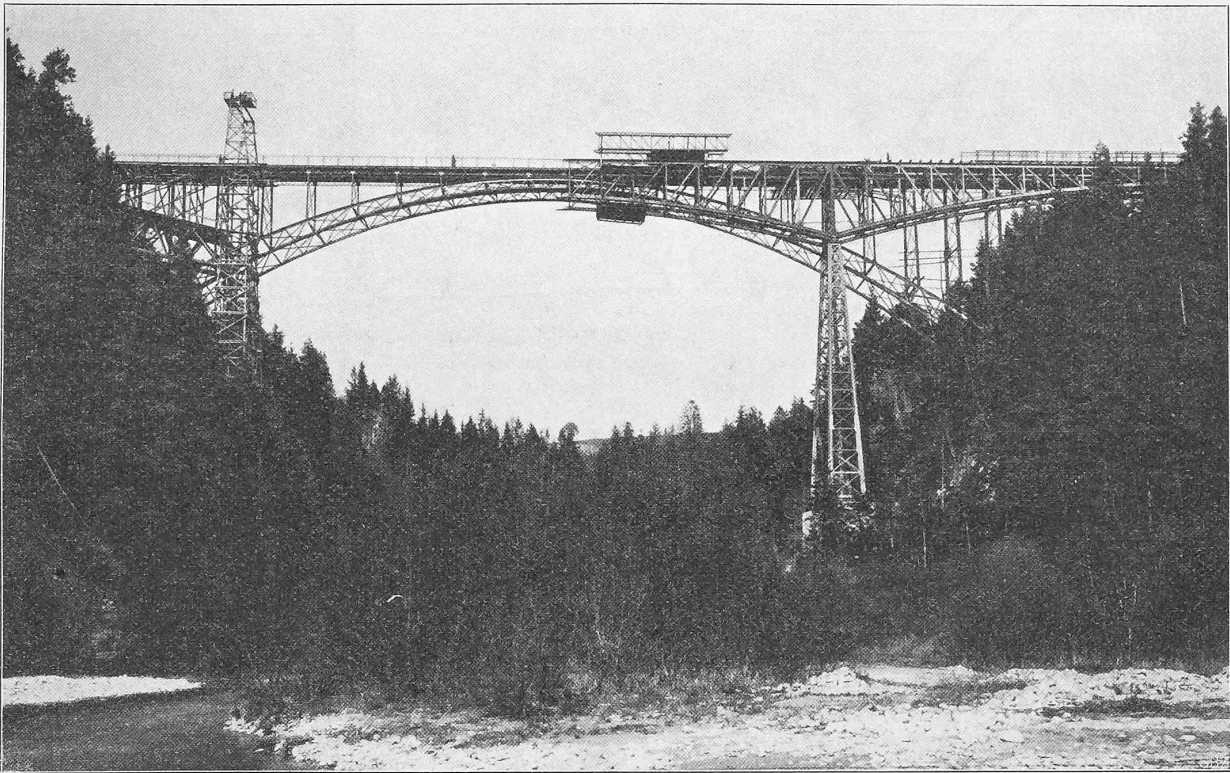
Brücke im Bau mit dem Montierengerüst. — Dahinter die bestehende Strassenbrücke.
